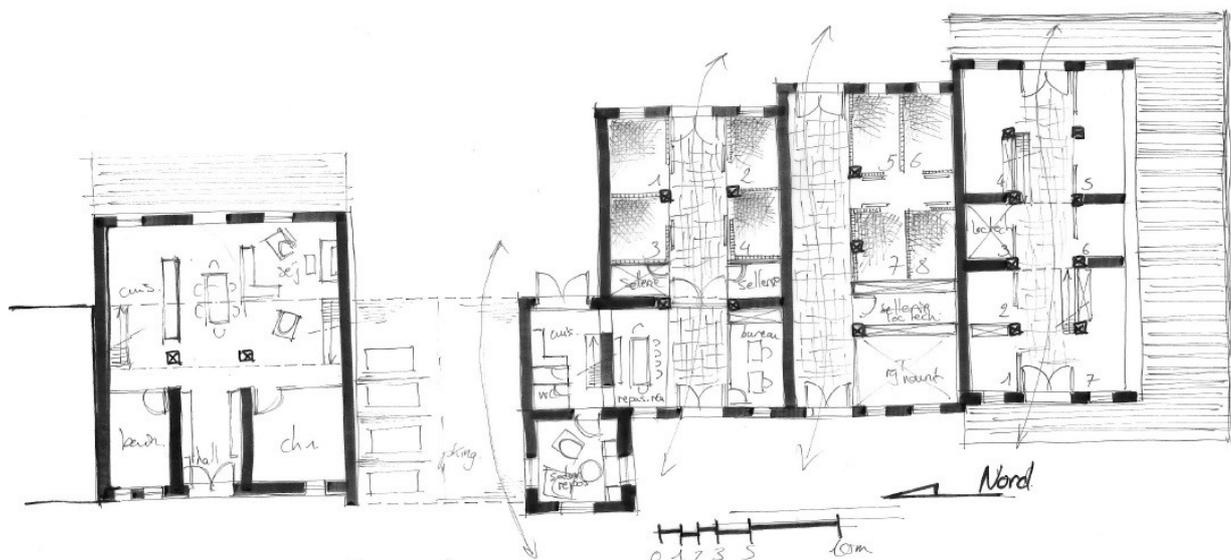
plan schématique des aménagements intérieurs (Mazeley-centre équestre)
